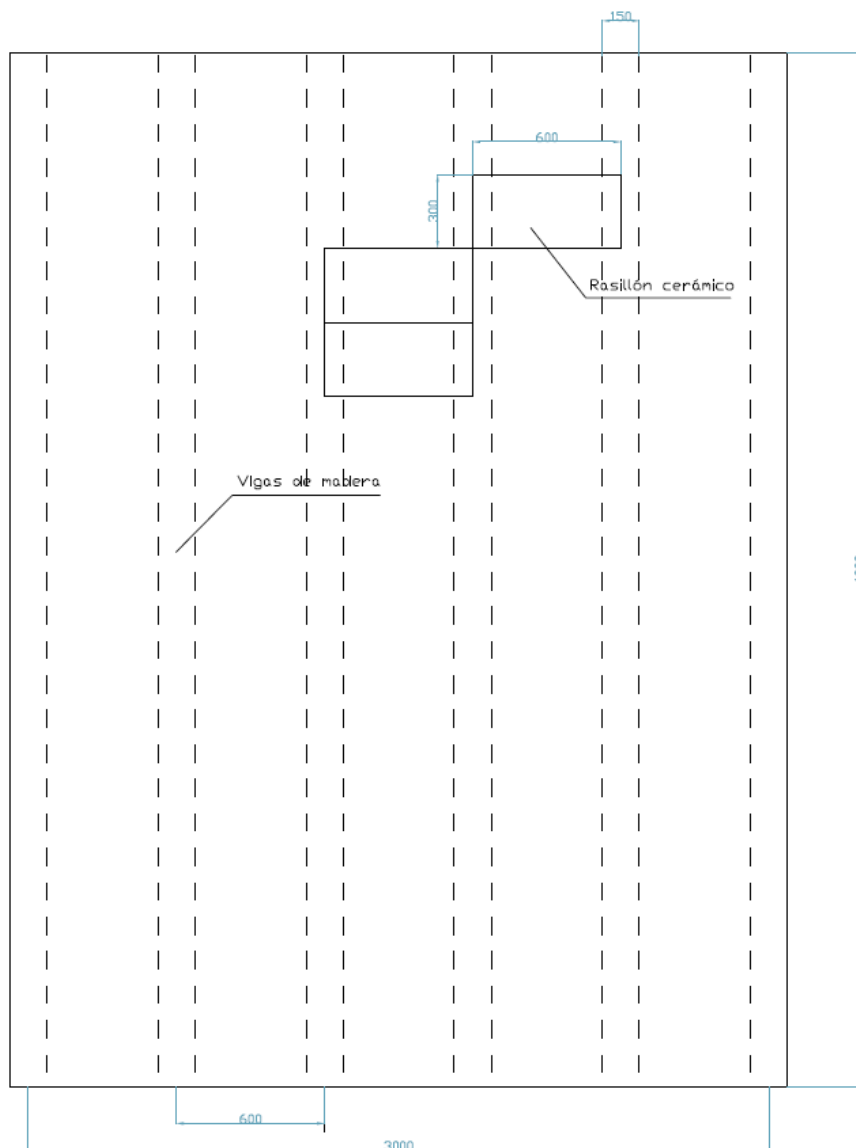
Distribución de las vigas de madera y el rasillón cerámico.
